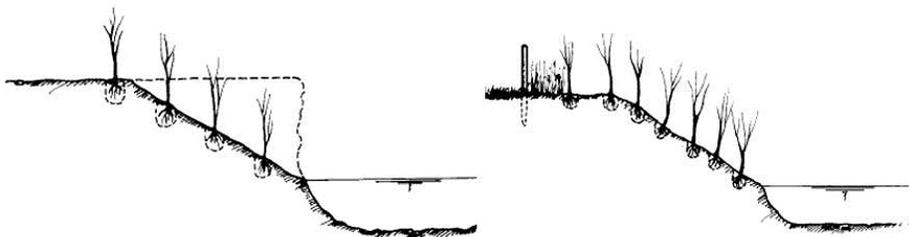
Exemplo de uma intervenção de reperfilamento e plantação de uma margem ravinada (adaptado de Jund *et al.* 2000)
